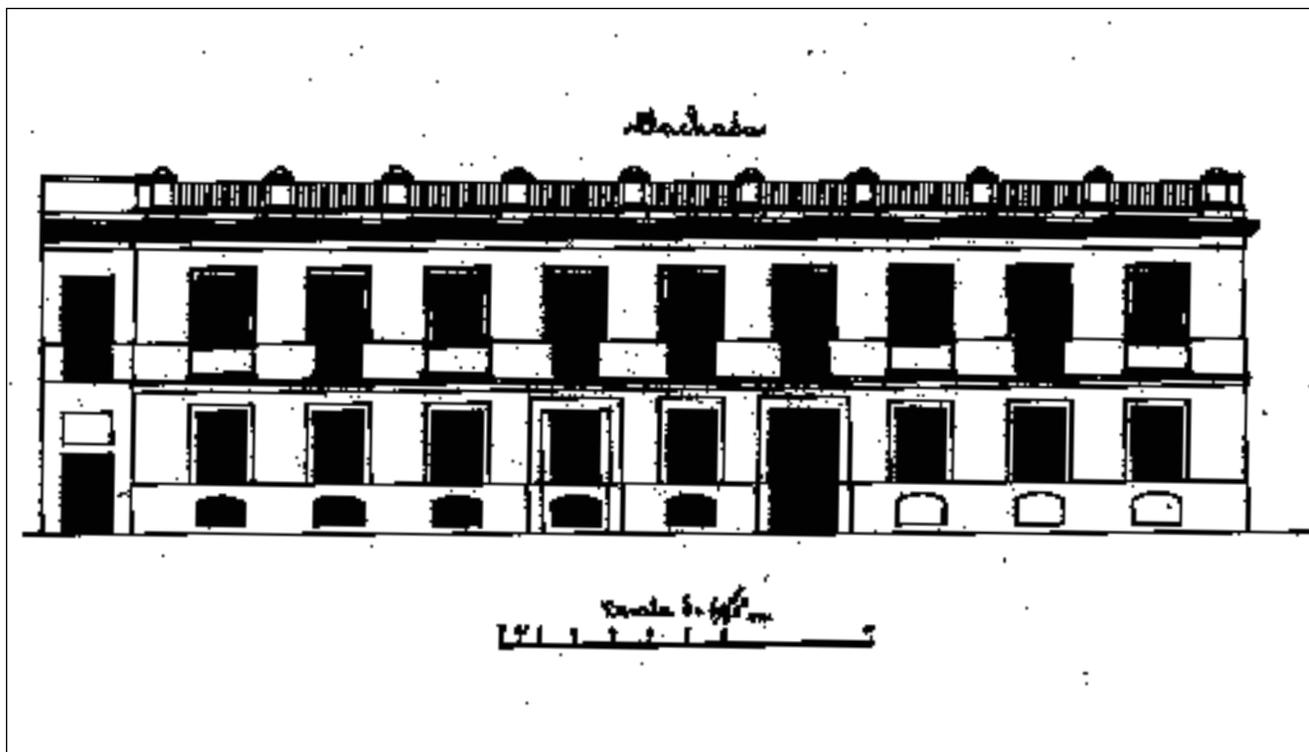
Proyecto de fachada del hotel-balneario de 1848.
